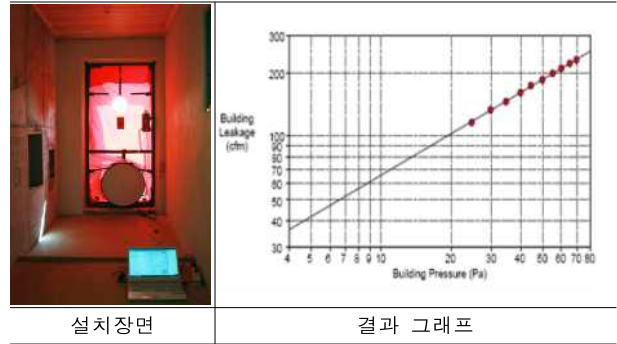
1차 예비 Blower Door 설치 장면 및 결과 그래프
